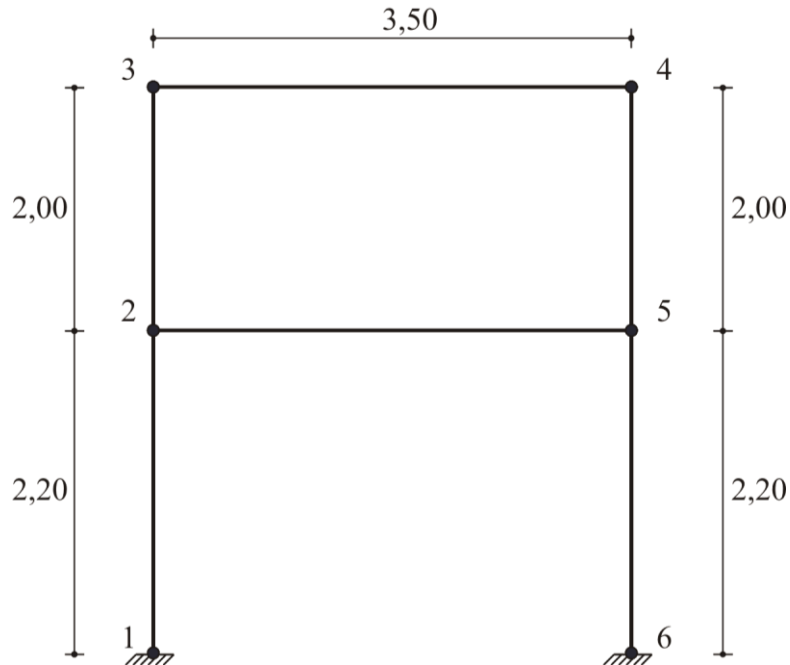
Exemplo 2: Malha de elementos finitos do pórtico em concreto armado (dimensões em metros).
